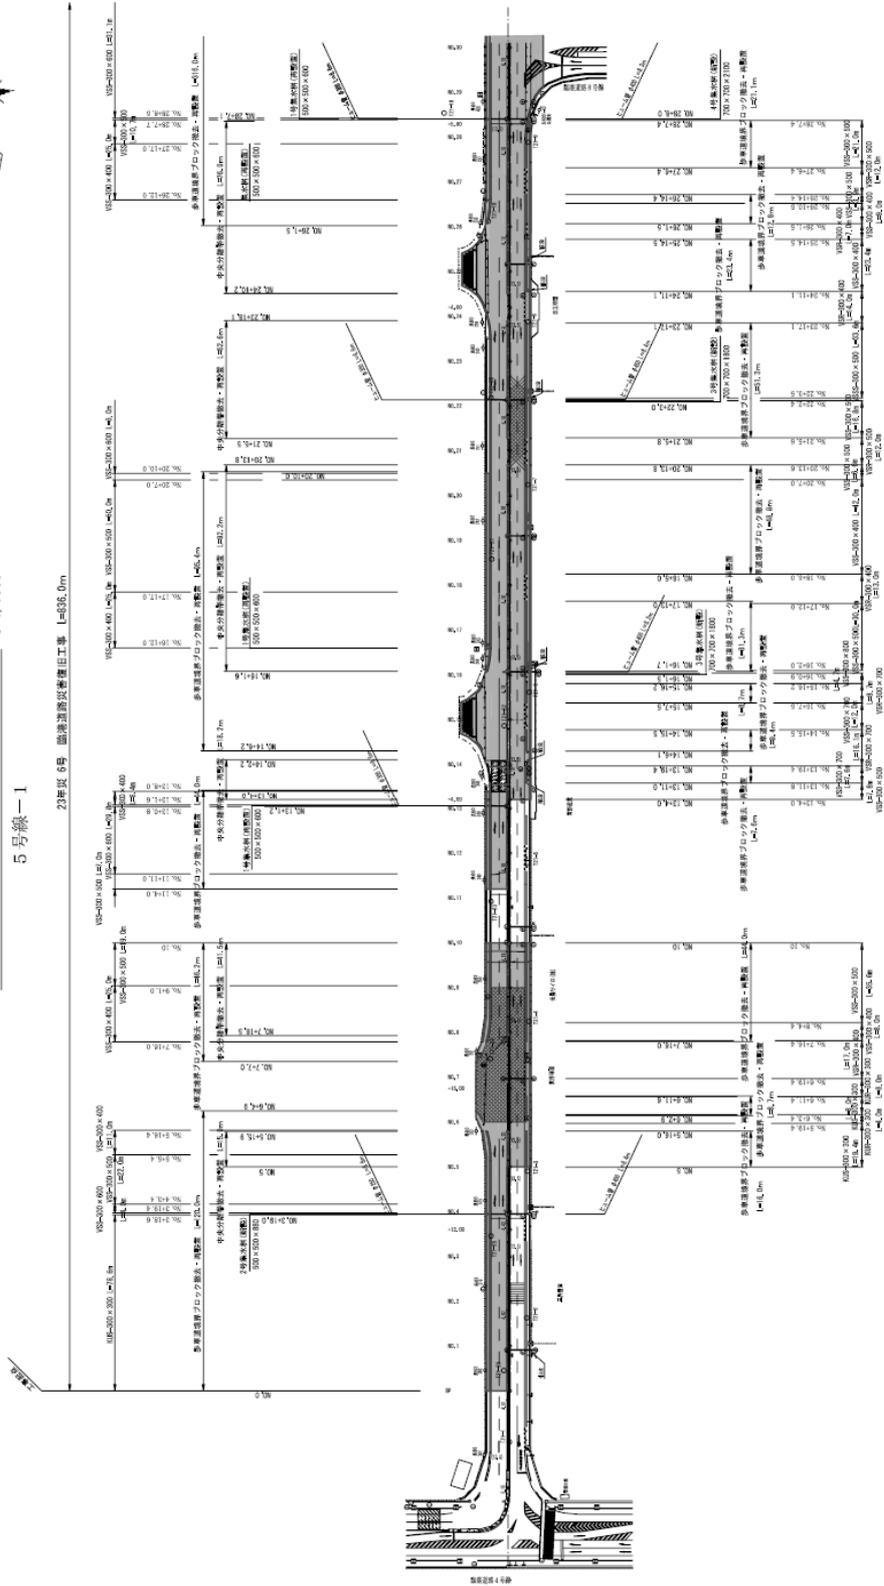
349 No.9 常陸那珂港区_臨港道路 5号線の平面図① (復旧後)
